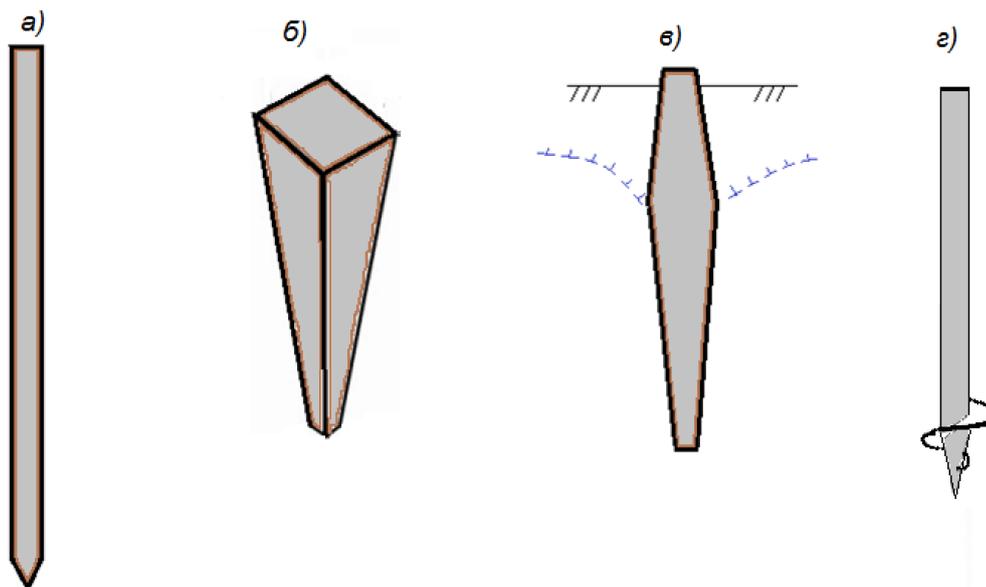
Основные виды готовых свай по форме продольного сечения: а) – призматические; б) – пирамидальные; в) – ромбовидные; з) – винтовые (лопастные)
